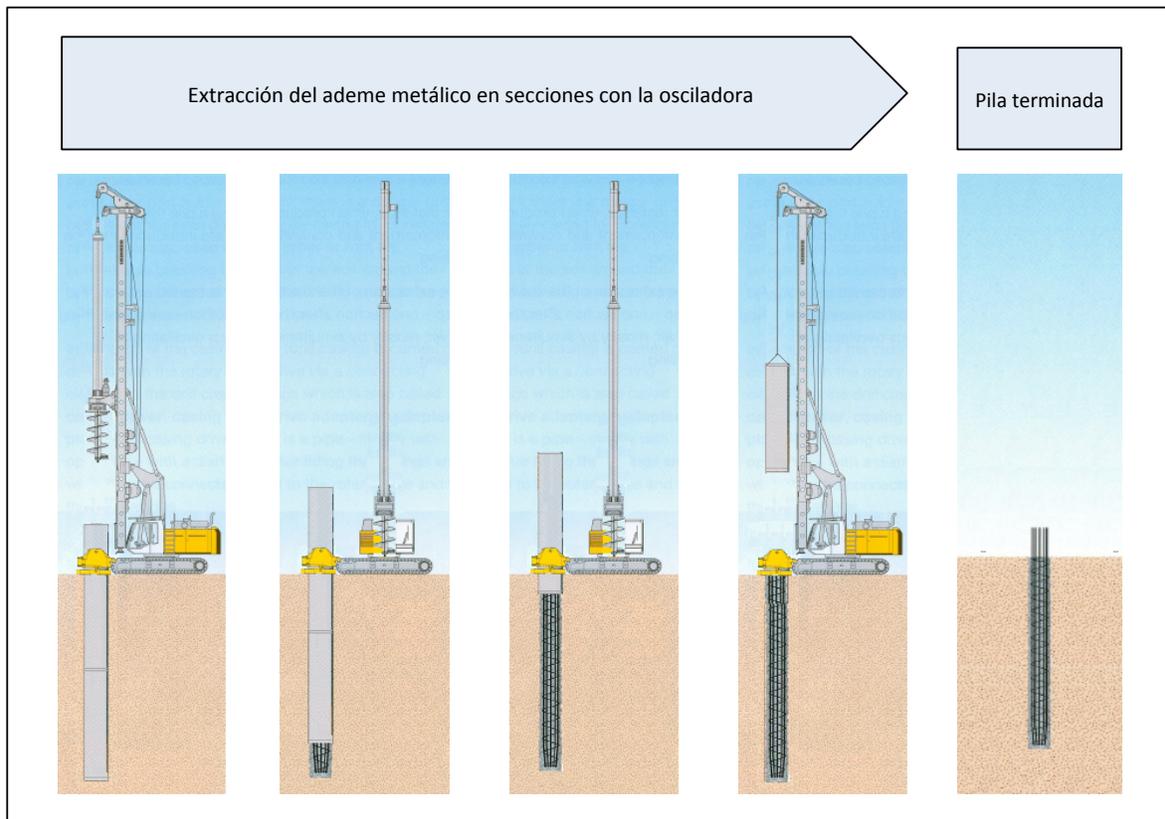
Procedimiento constructivo. Izaje de acero de refuerzo y colado de pila
